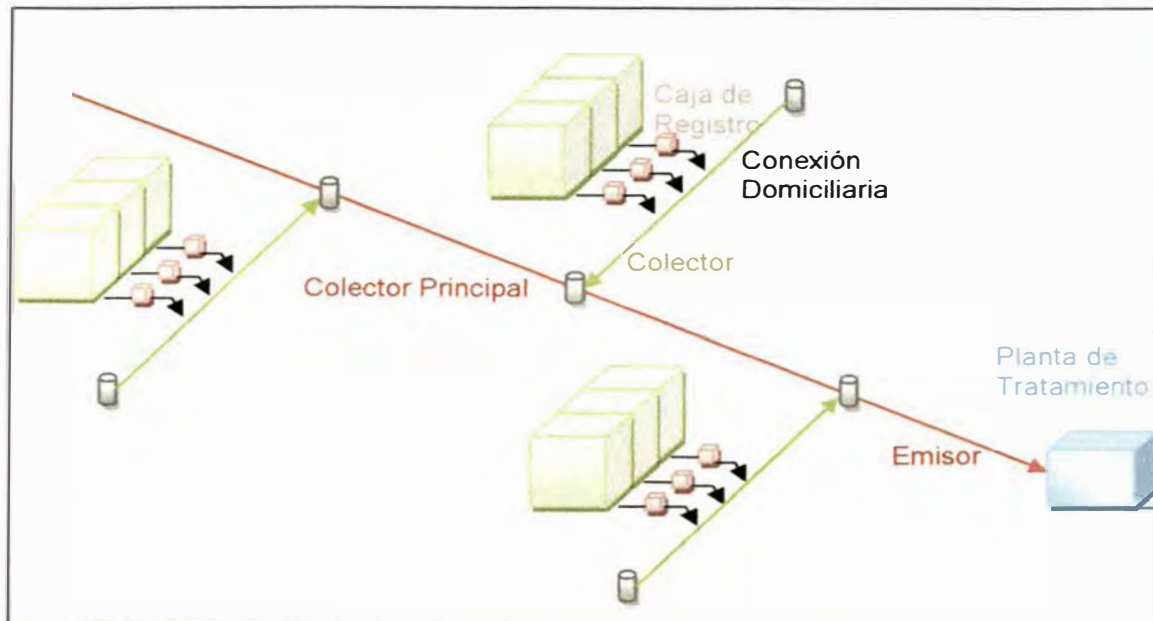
Esquema del Sistema de Alcantarillado
